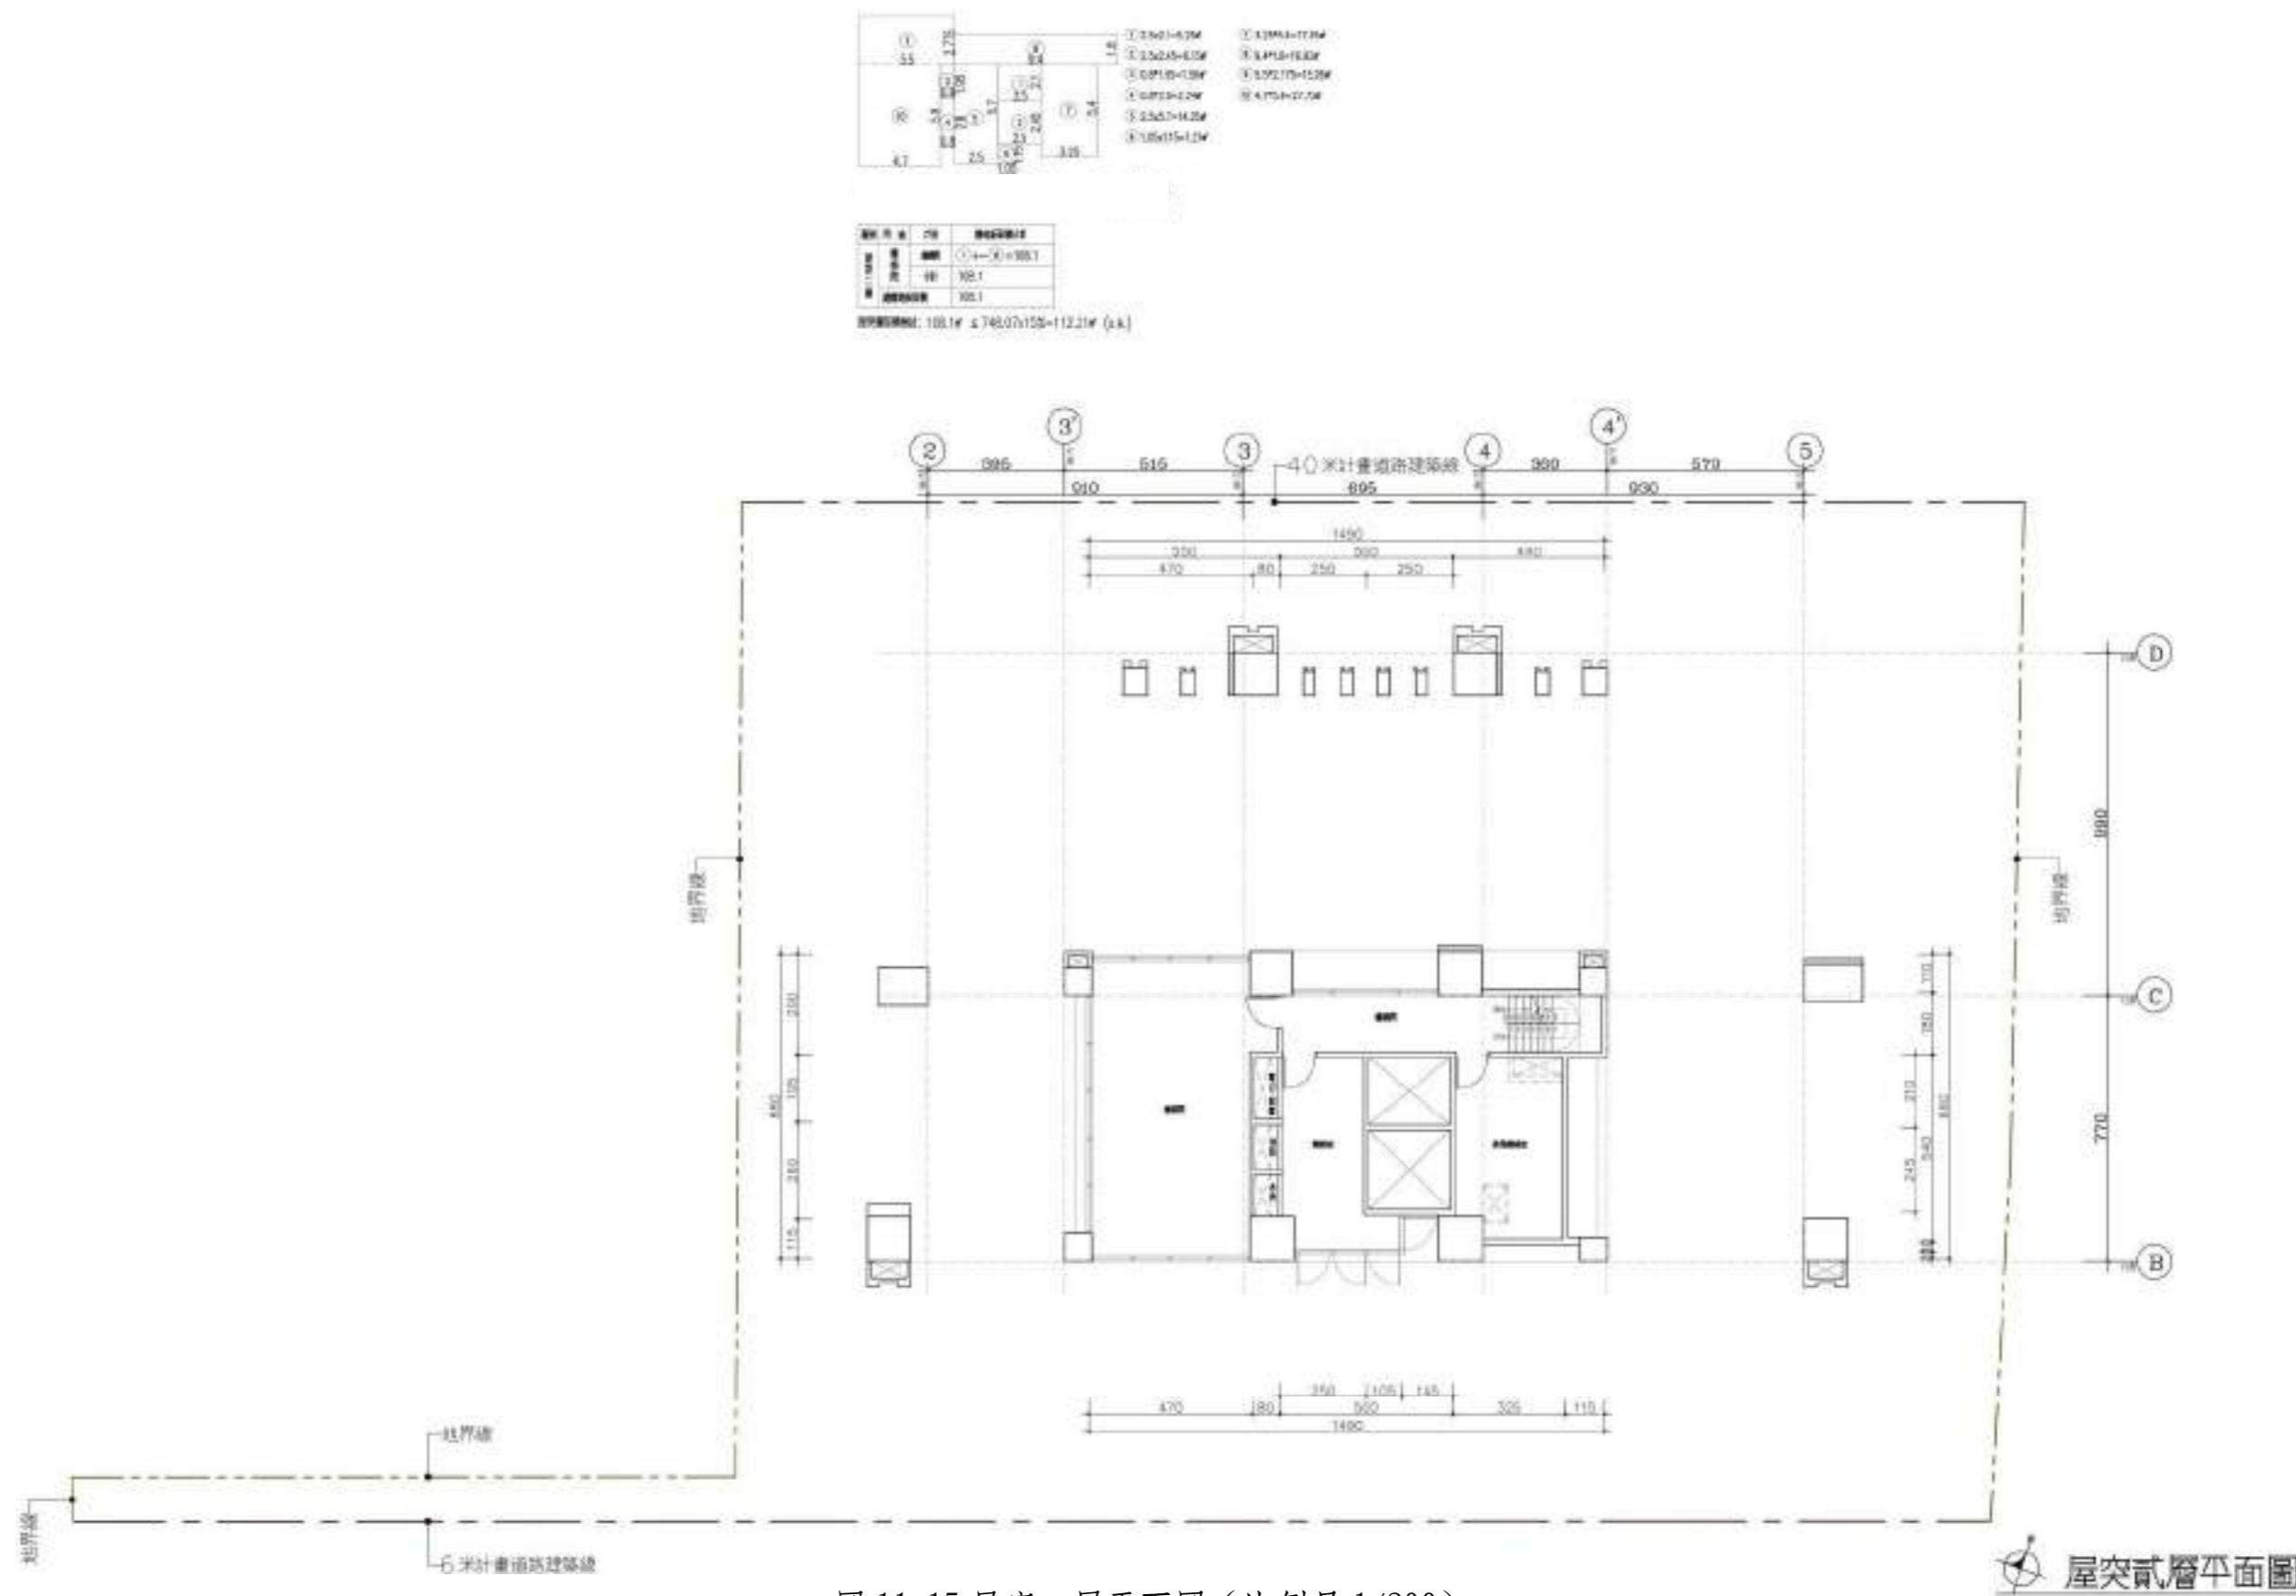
屋突二層平面圖 (比例尺 1/200)
